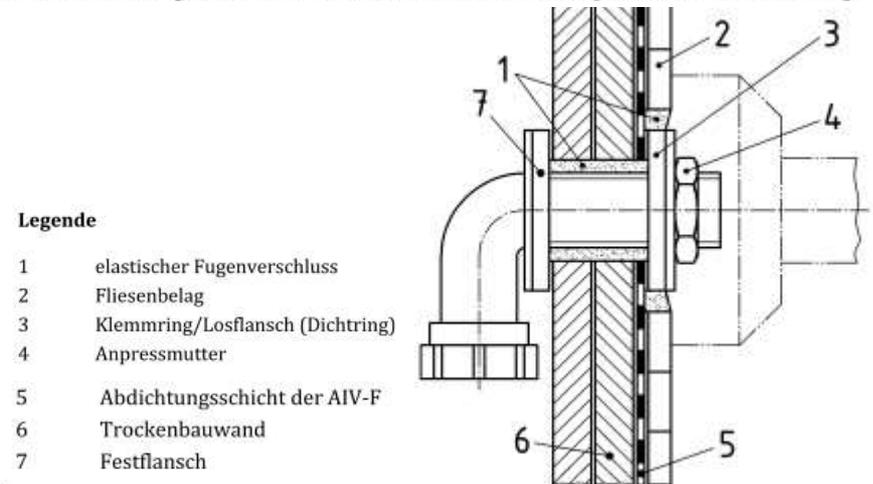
Rohrdurchführung bei einer Trockenbaukonstruktion mit Anpressmutter und Dichtringen
